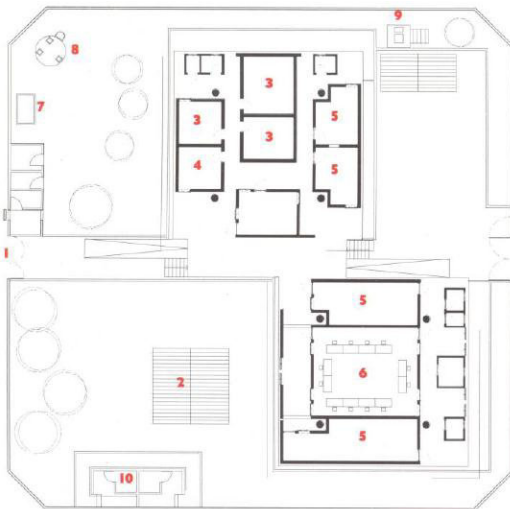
Planta de Distribución Centro de Bienestar para la Mujer
